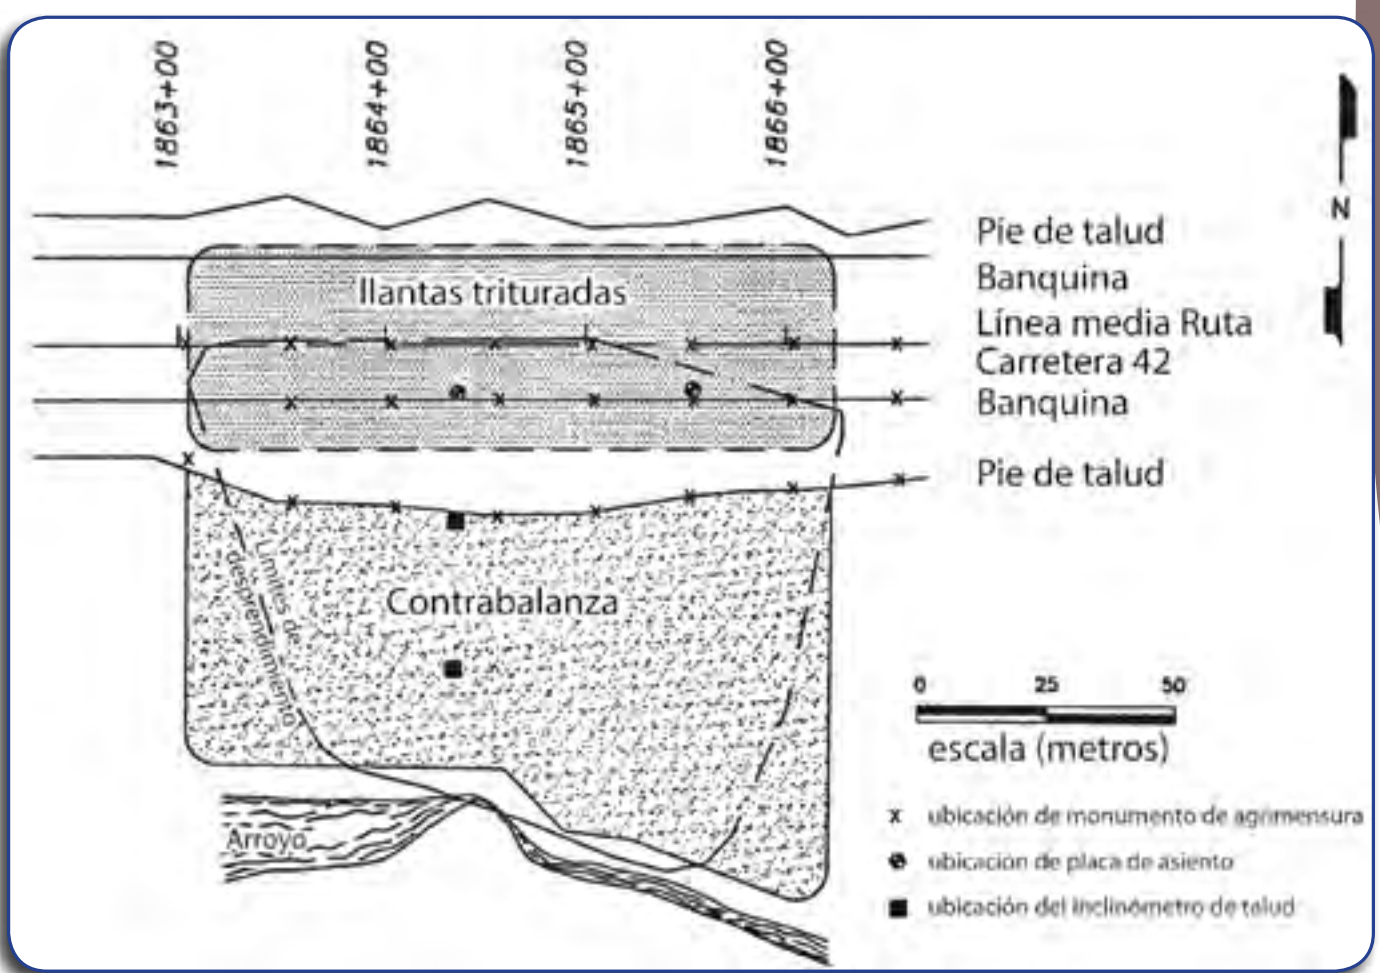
Planta y alzado de la prueba de campo de llantas trituradas en Oregon (Ref. 47)
